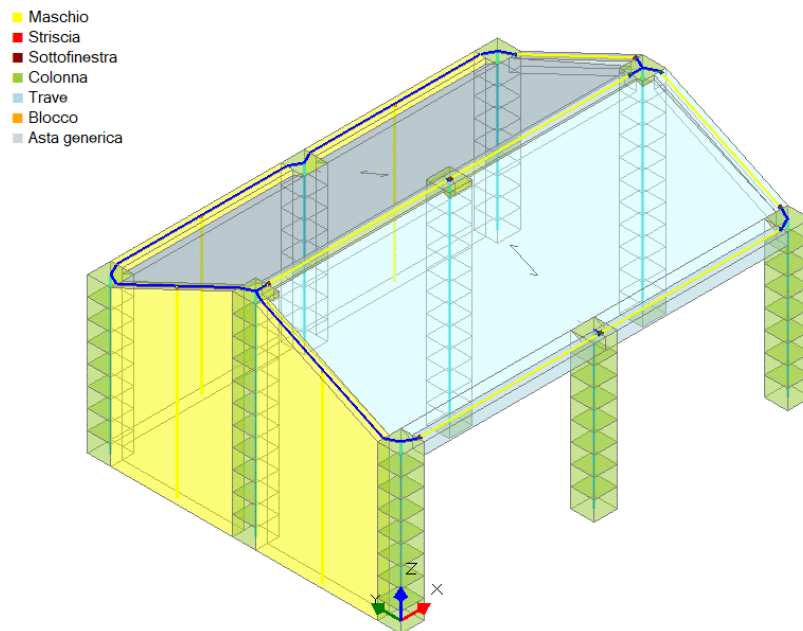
Costruzione Rurale in Muratura: Modello Strutturale, vista per Tipologia
